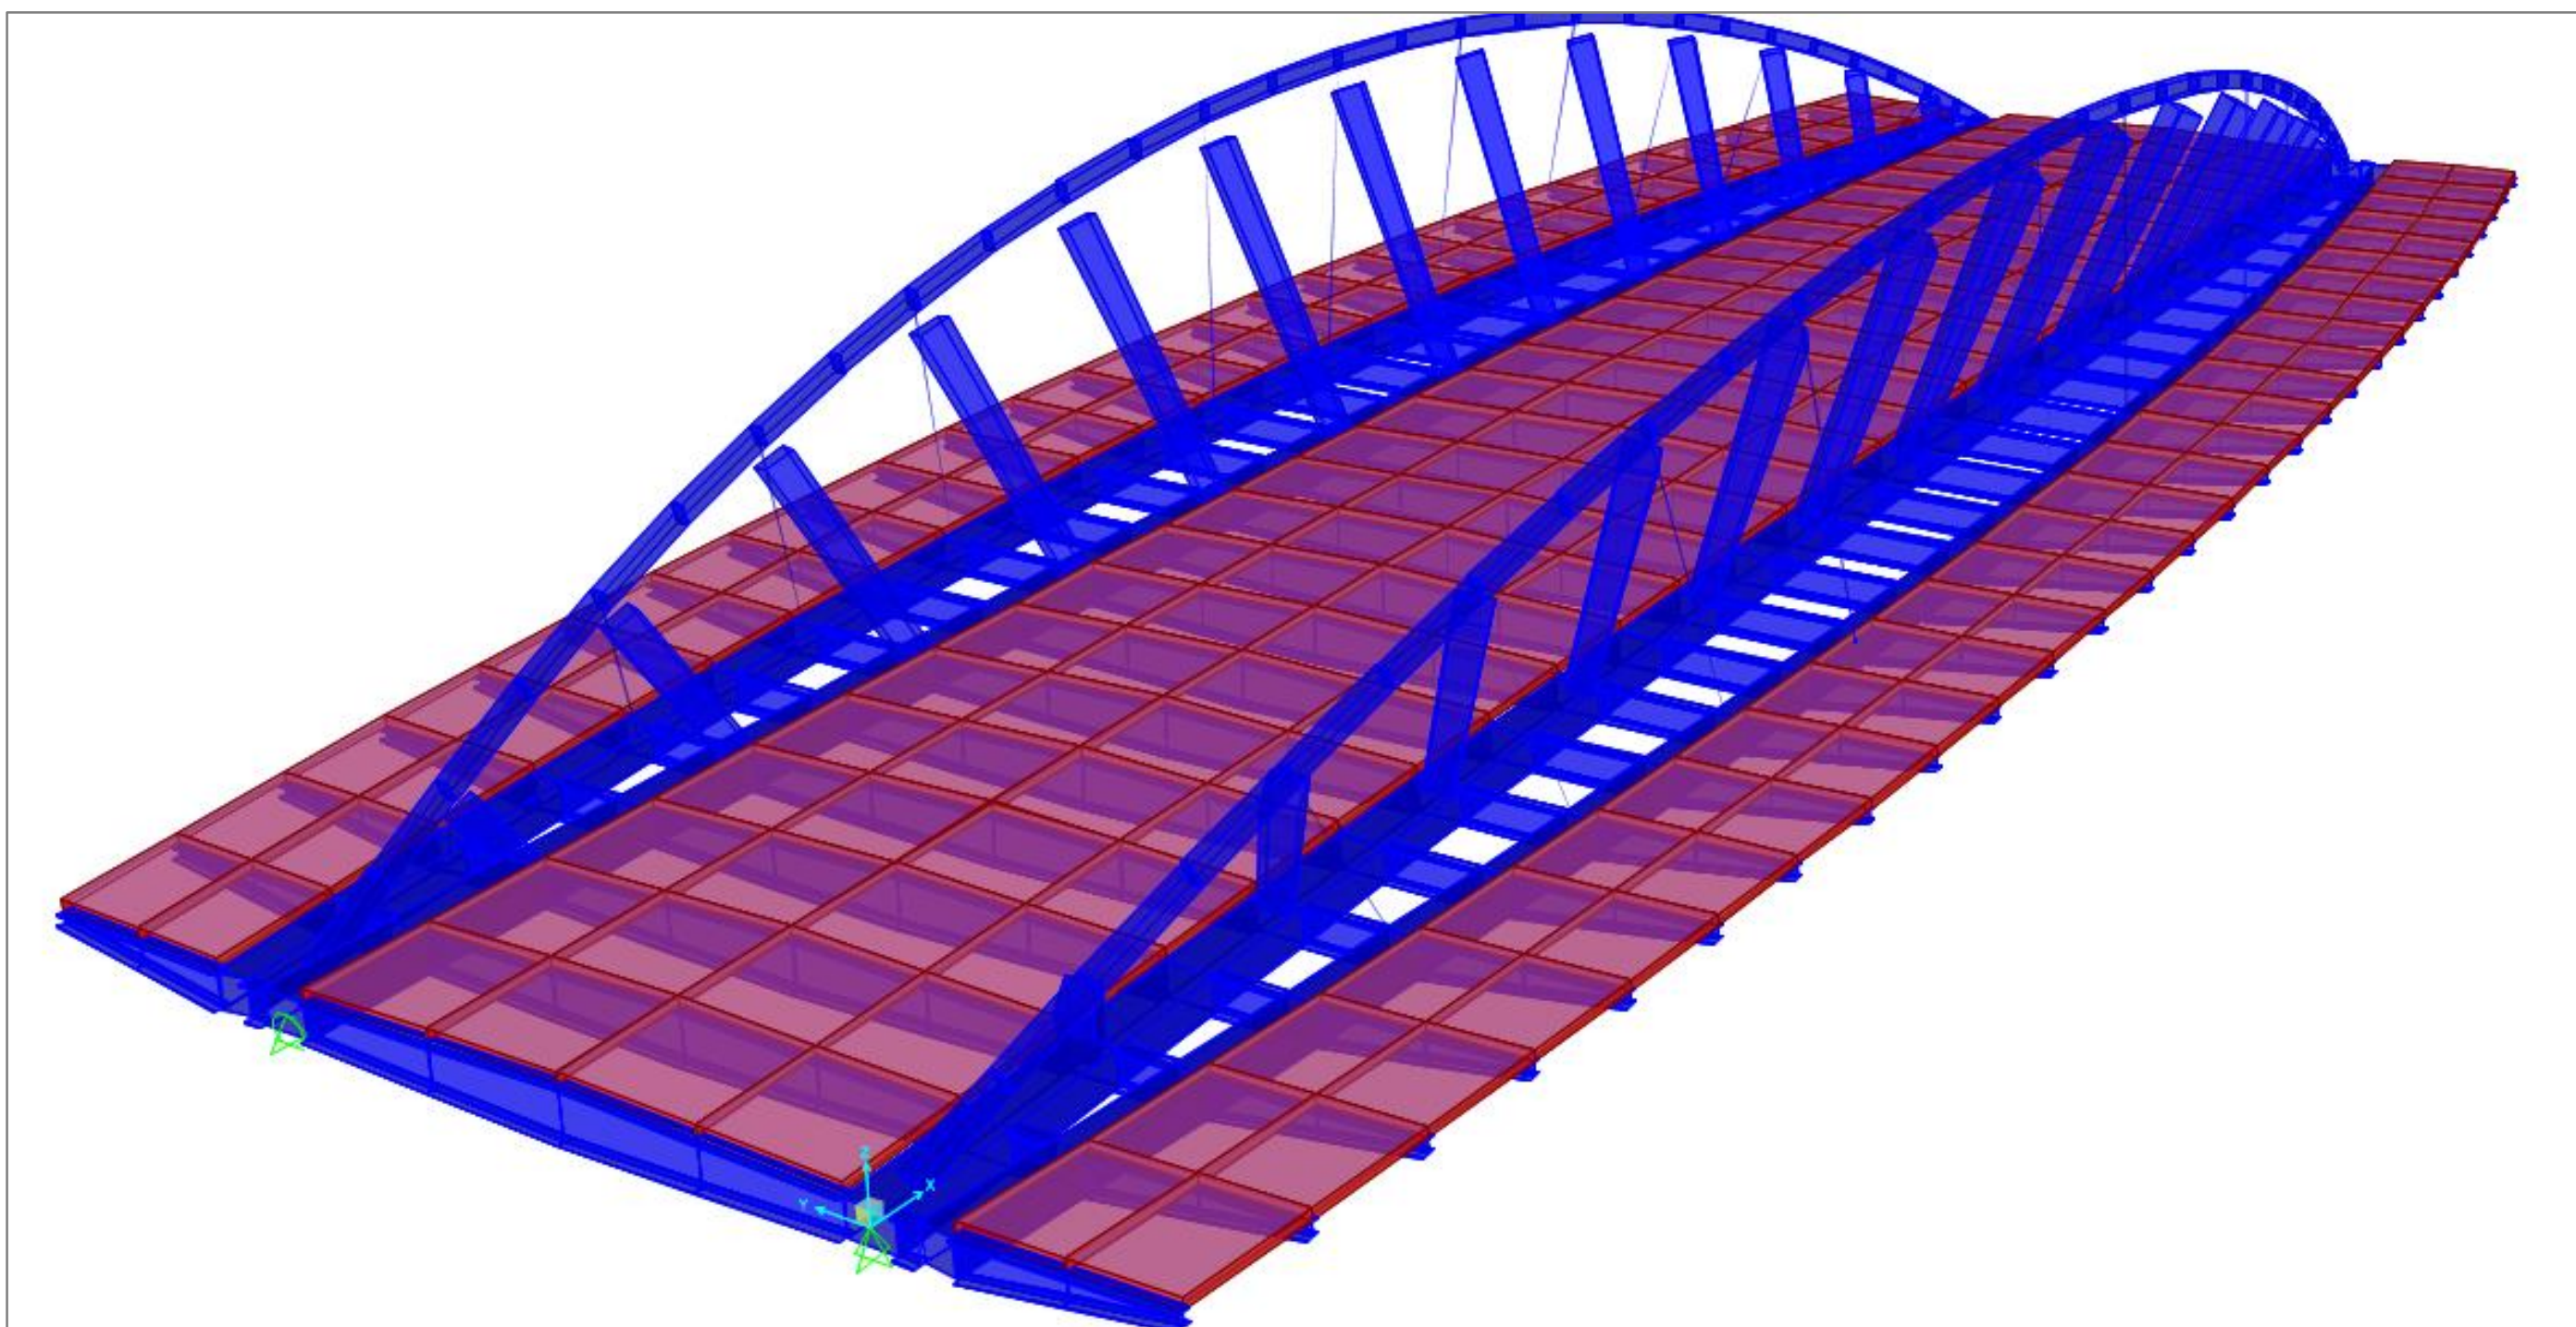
Alzado transversal del modelo estructural en SAP 2000
